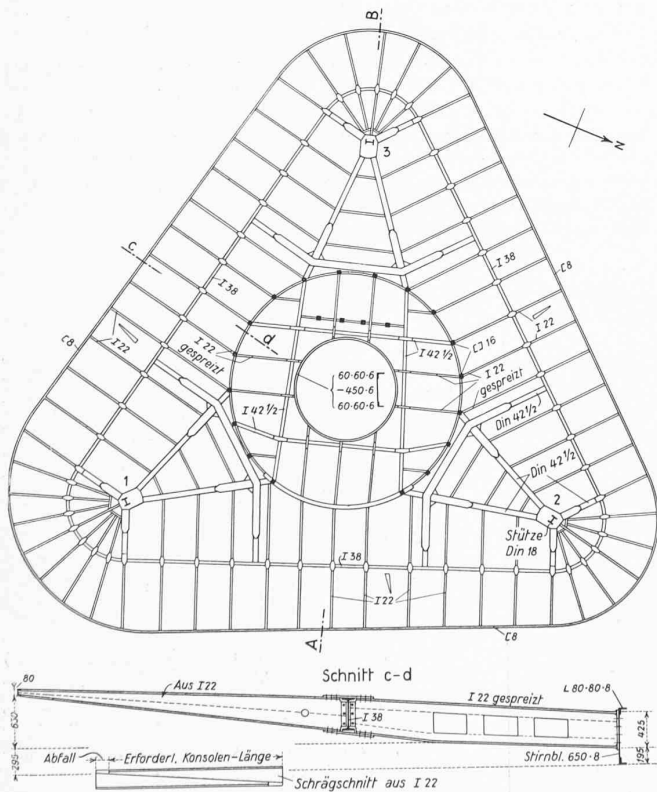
(oben) Draufsicht auf die Dachkonstruktion. — 1 : 400
